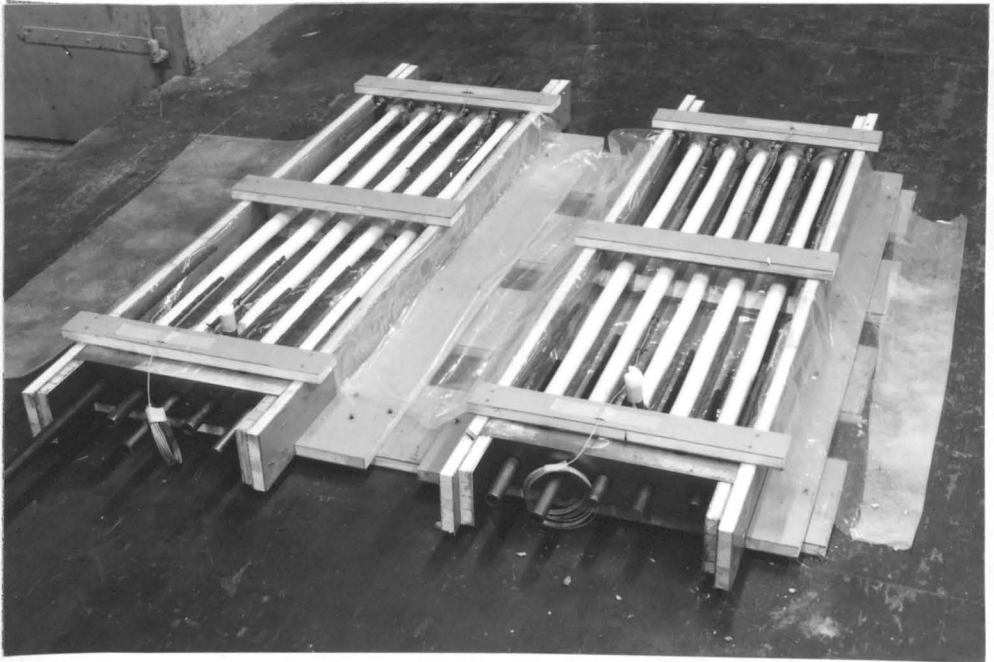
Schalung und Bewehrung der Spannbetonscheiben
